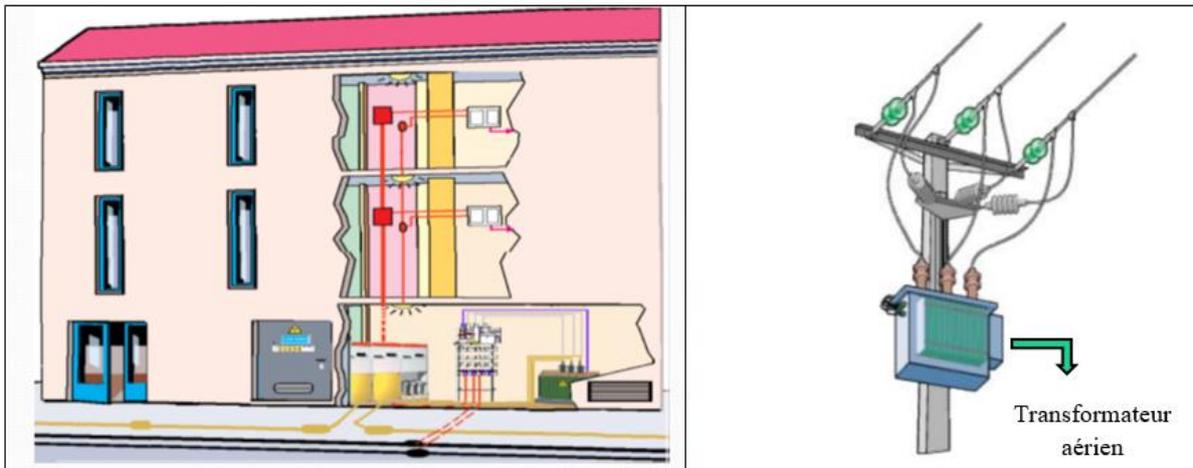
Structure d'installation d'un poste en immeubles / sur poteau [25], [26].
